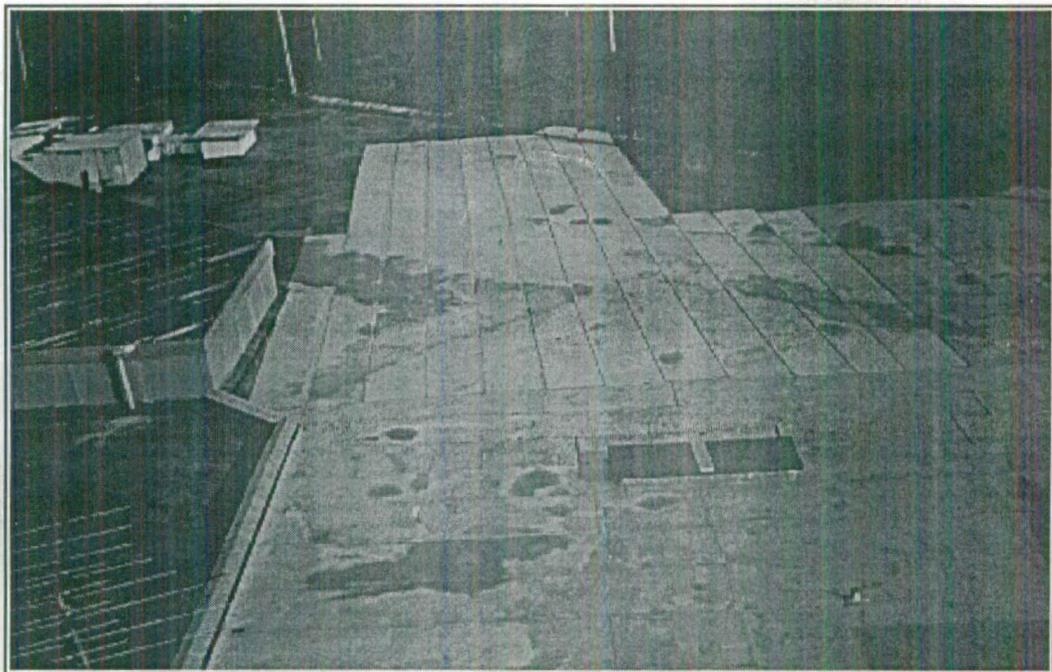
Vista de cubierta impermeabilizada y lucernario en zona de Apoyo Administrativo.
